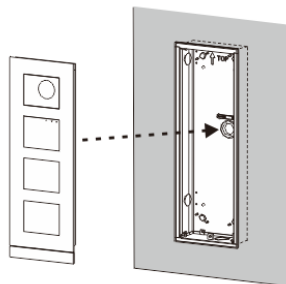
Montagem embutida apenas com uma caixa de montagem embutida
